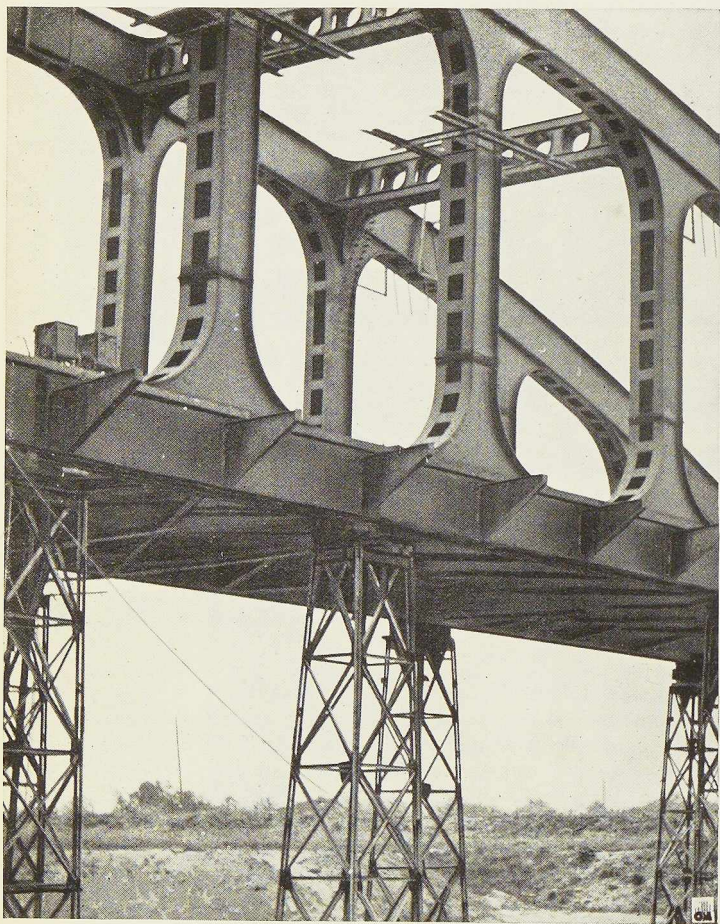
Vue prise en cours de montage. On note la constitution en caisson des poutres principales. A la partie supérieure des montants, on voit deux plates-formes volantes pour soudeurs.
